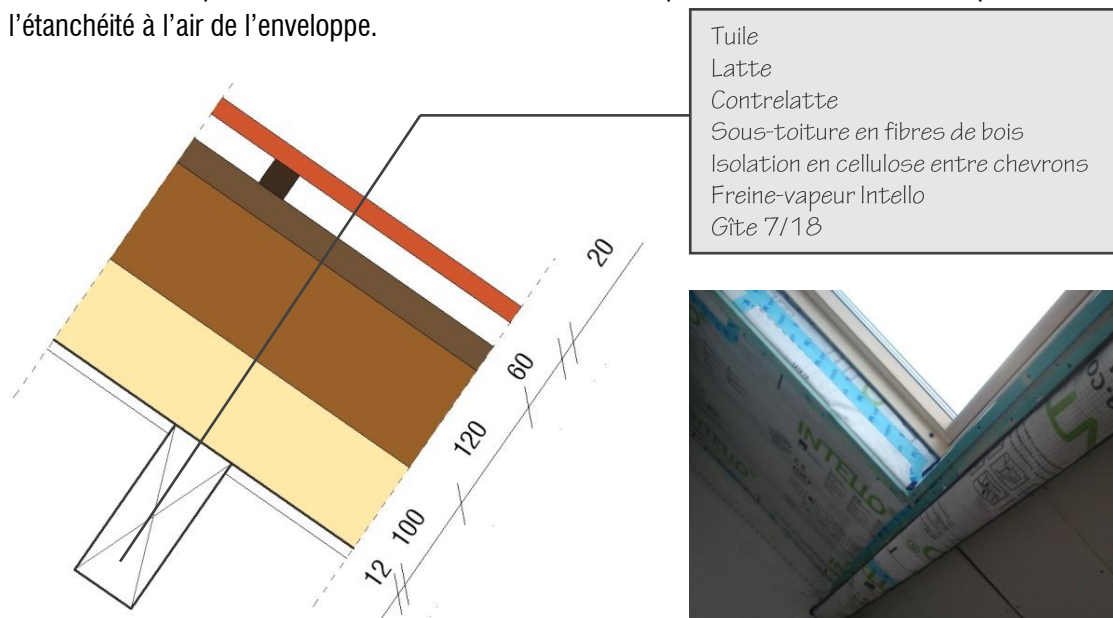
Détail du renforcement de la toiture, mesures en [mm]
